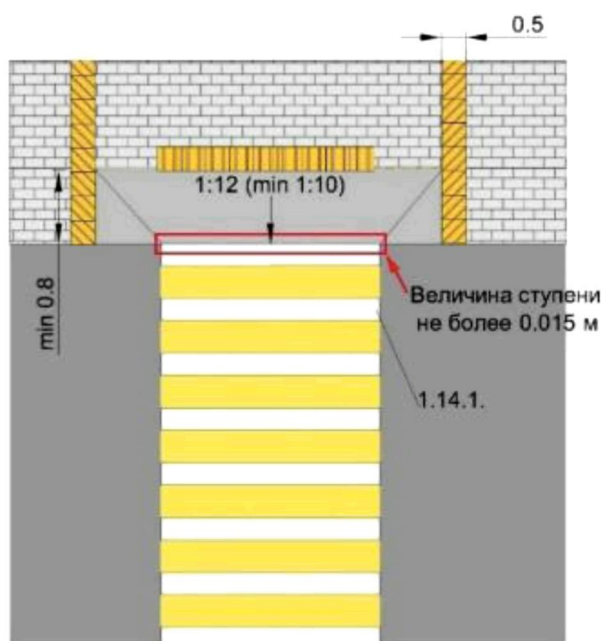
Пример наземного пешеходного перехода, оборудованного пандусным сходом и тактильной плиткой
